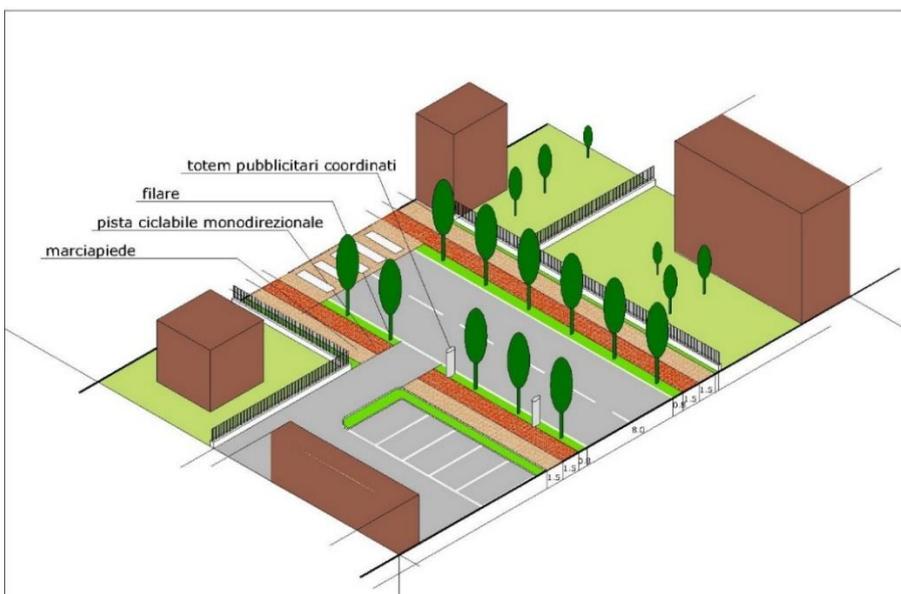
Rappresentazione schematica stato di progetto sezione 4
